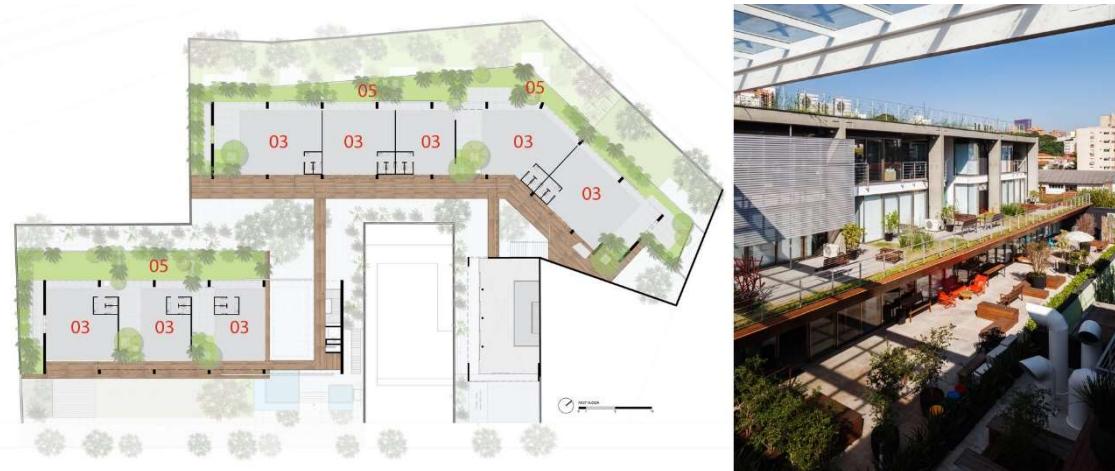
(à esquerda): Planta Baixa 1º Pavimento (03 – Escritórios | 05 – Tetos Jardins).
